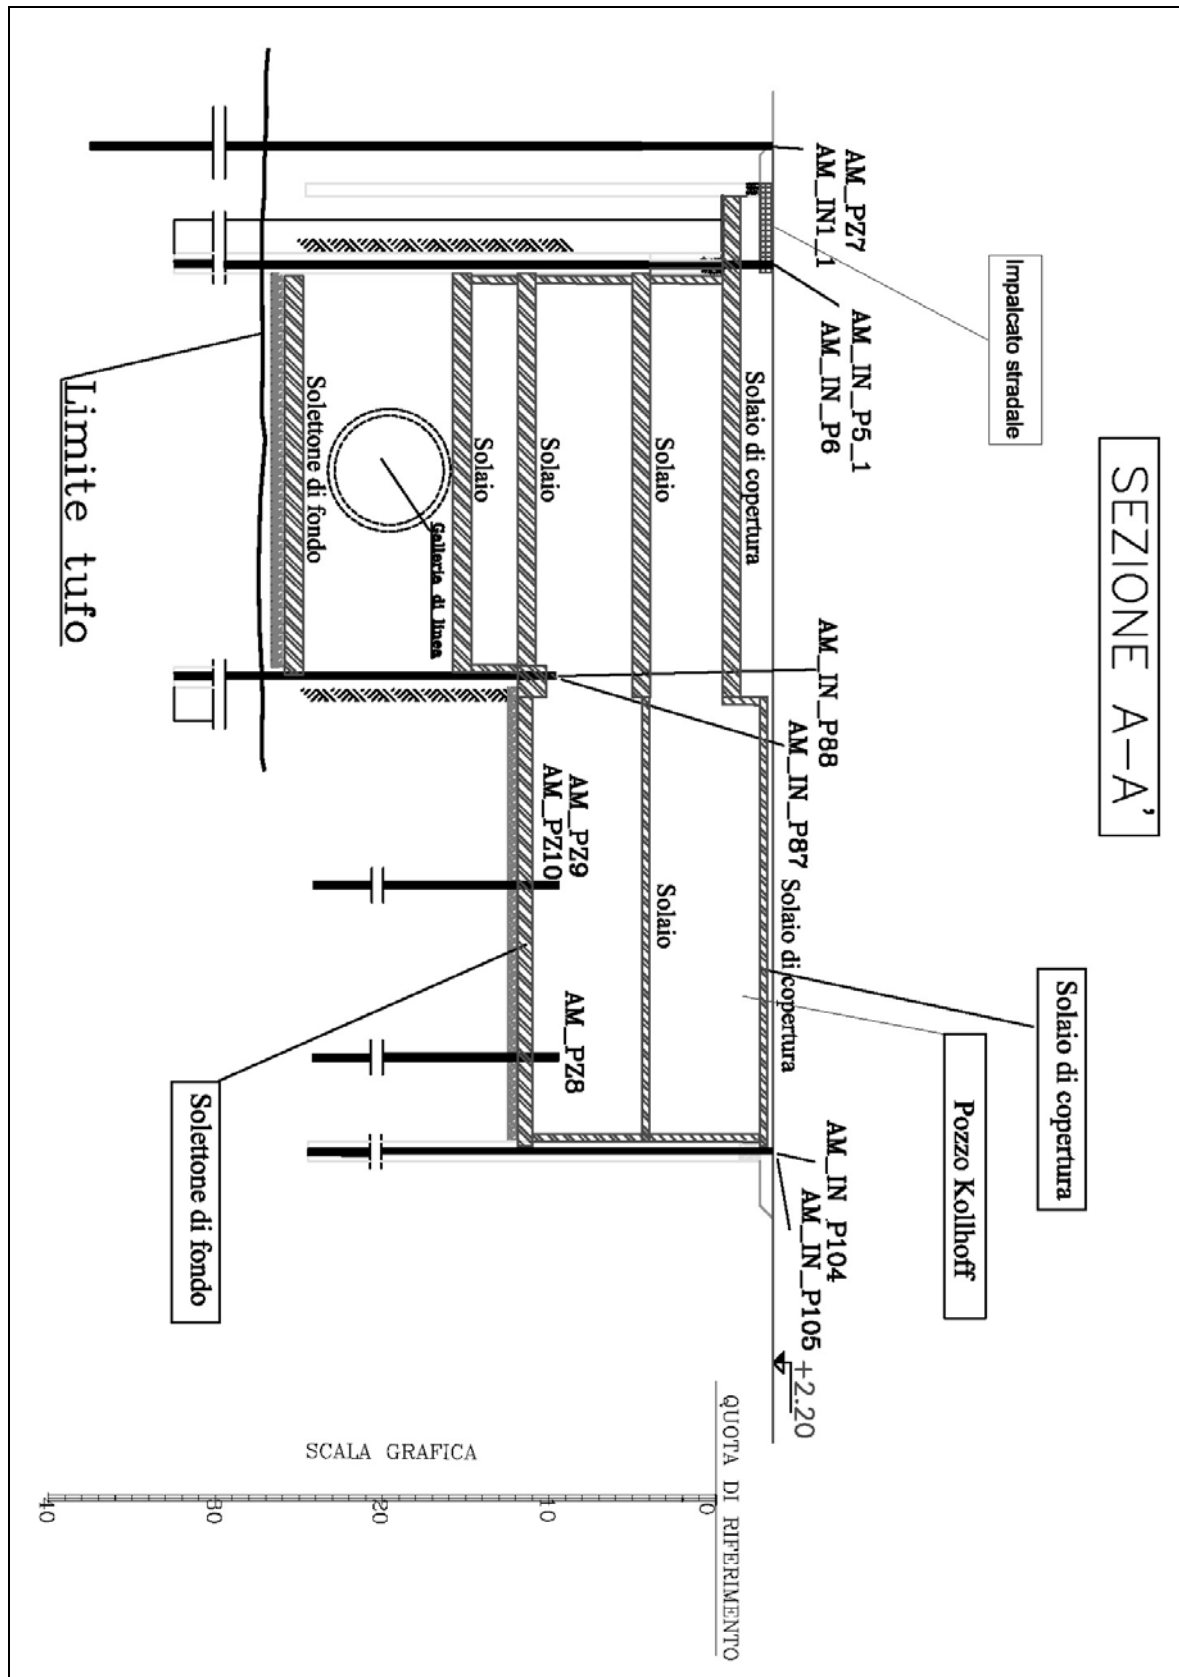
Sezione A-A' pozzo stazione, raffigurante la suddivisione in aree di lavoro.
